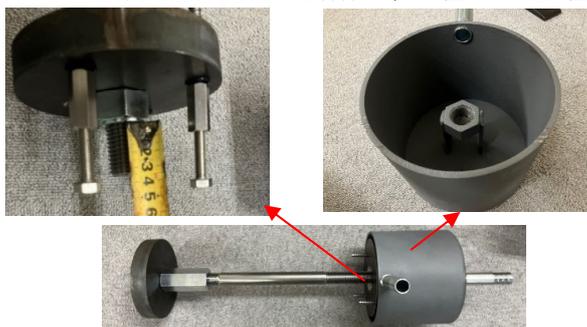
支圧板、脱落防止用アンカー、防錆カバー
